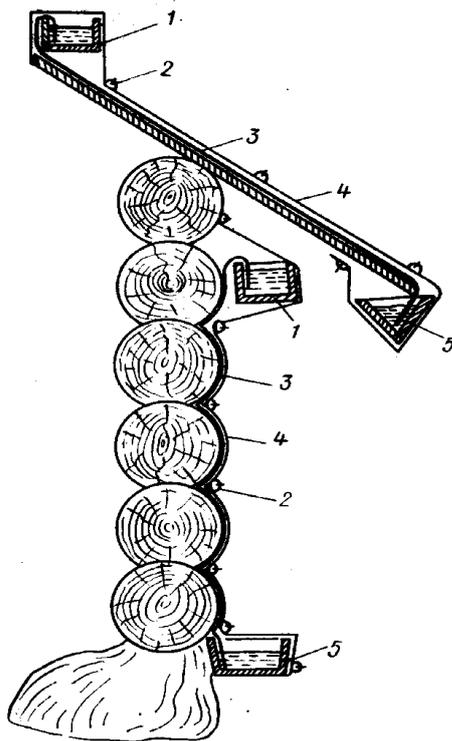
Схема панельной пропитки бревенчатой стены и дощатой кровли: 1 – резервуар-питатель; 2 – элементы крепления панели; 3 – внутренний слой панели; 4 – наружный слой панели; 5 – резервуар-сборник
